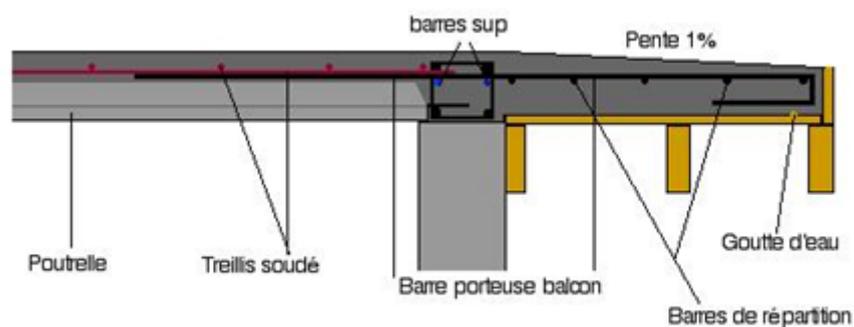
Schéma de ferrailage du balcon en béton armé.
